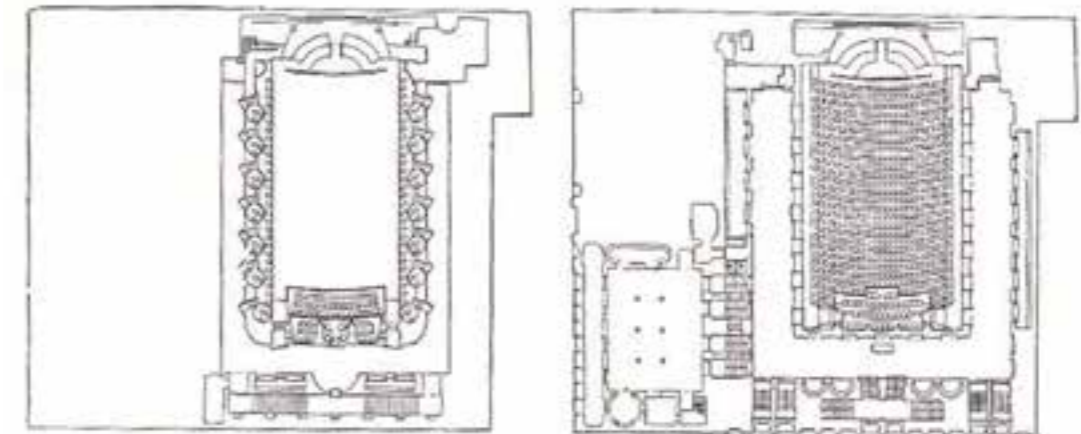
Esempio di pianta rettangolare, Cinema Scandia di Stoccolma, pianta galleria-pianta platea
